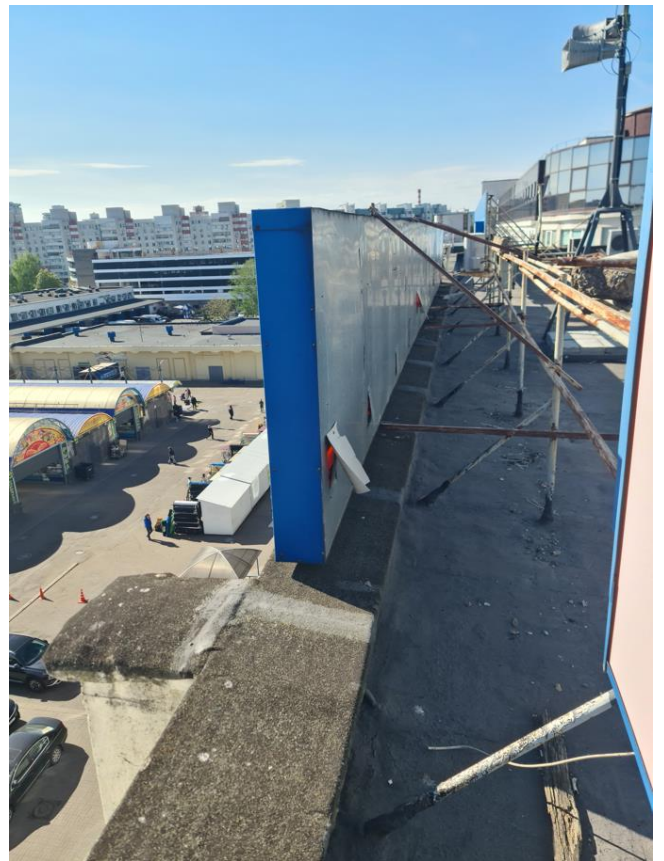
Общий вид крепления ограждающе-декоративных конструкций кровли в осях А/3-1
